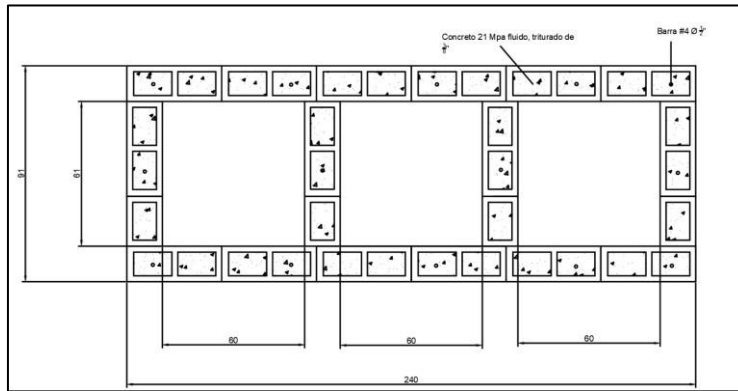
Planta del diseño tanque desarenador. Fuente: Elaboración propia.
